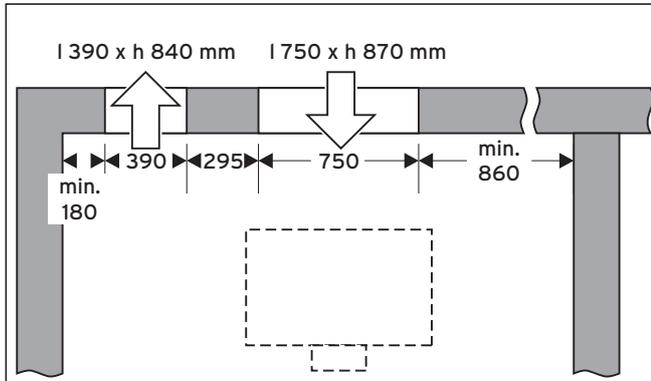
Installation sur un mur, sortie d'air à gauche
